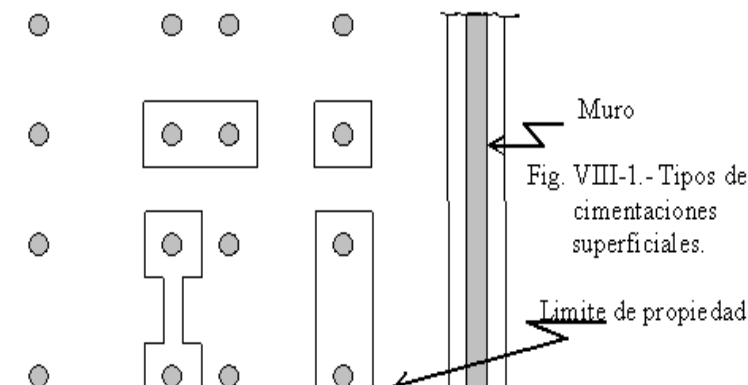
Tipos de cimentaciones superficiales.
